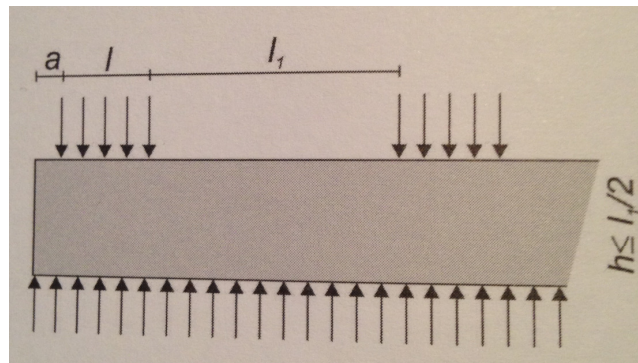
Viga continuamente apoiada (Negrão e Faria, 2009)
